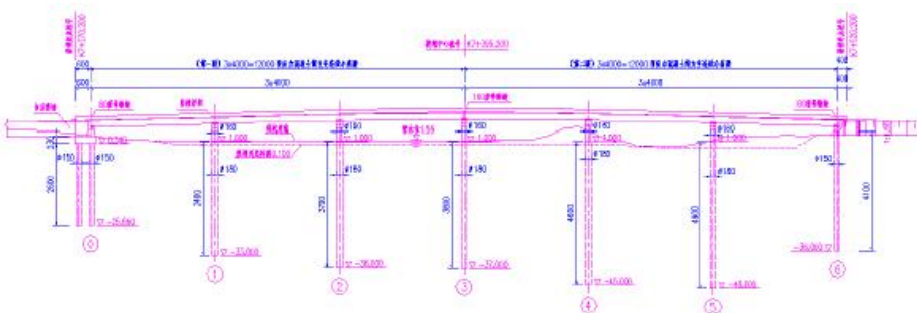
2x (3x40) m 预应力混凝土小箱梁立面图
